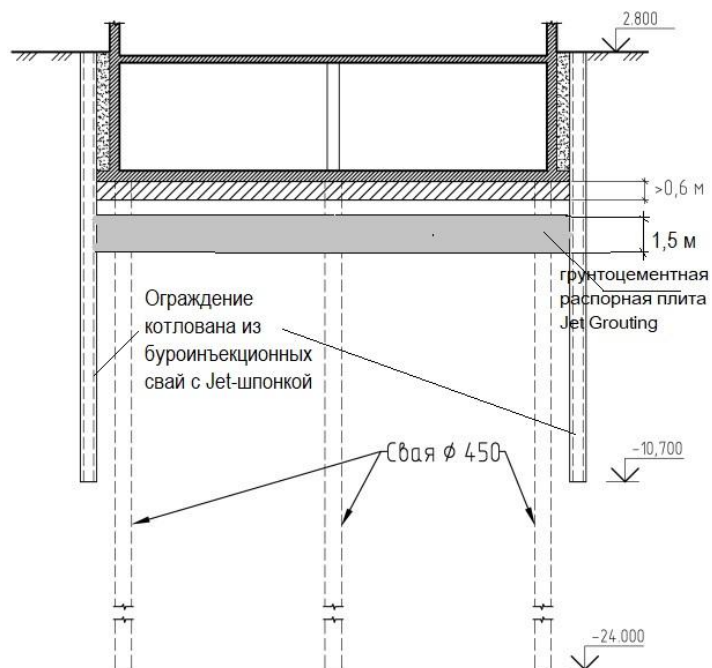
Конструктивное решение по устройству ограждения котлована и фундамента нового здания для устройства подземного сооружения
